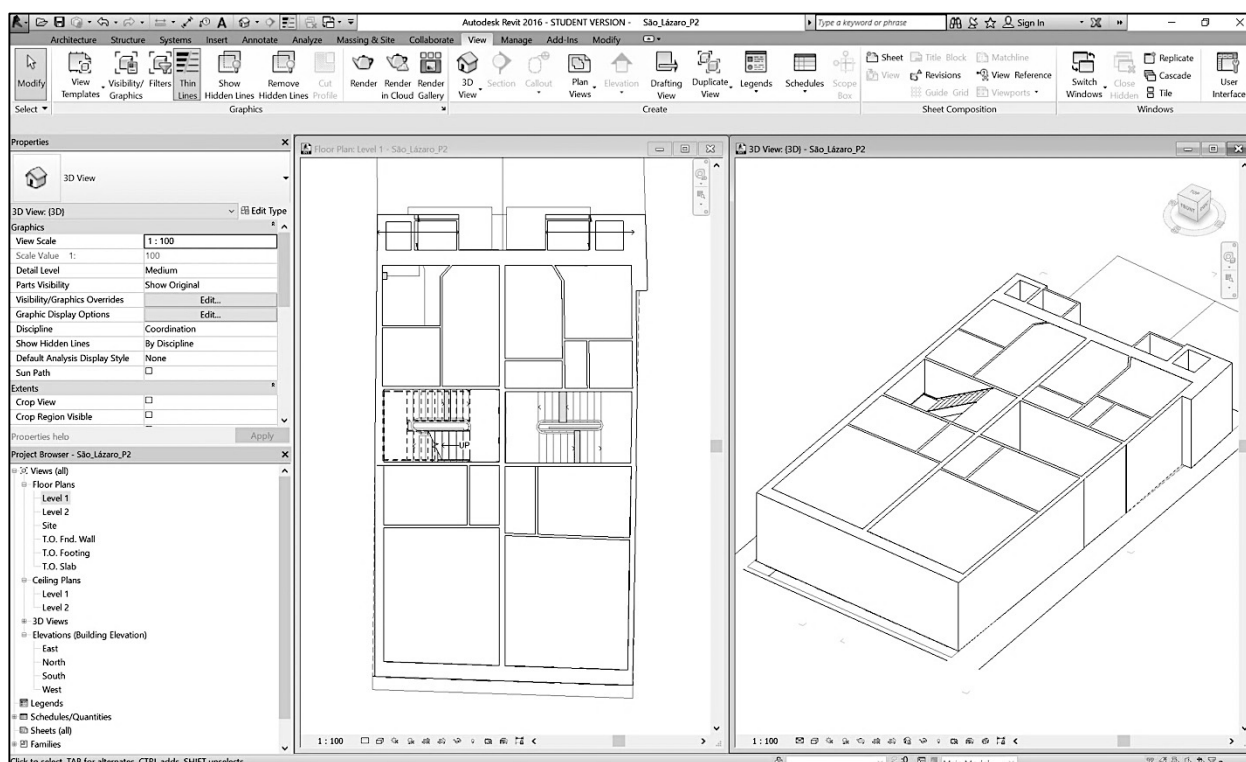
Vista em planta e 3D do início da modelação do edifício.
